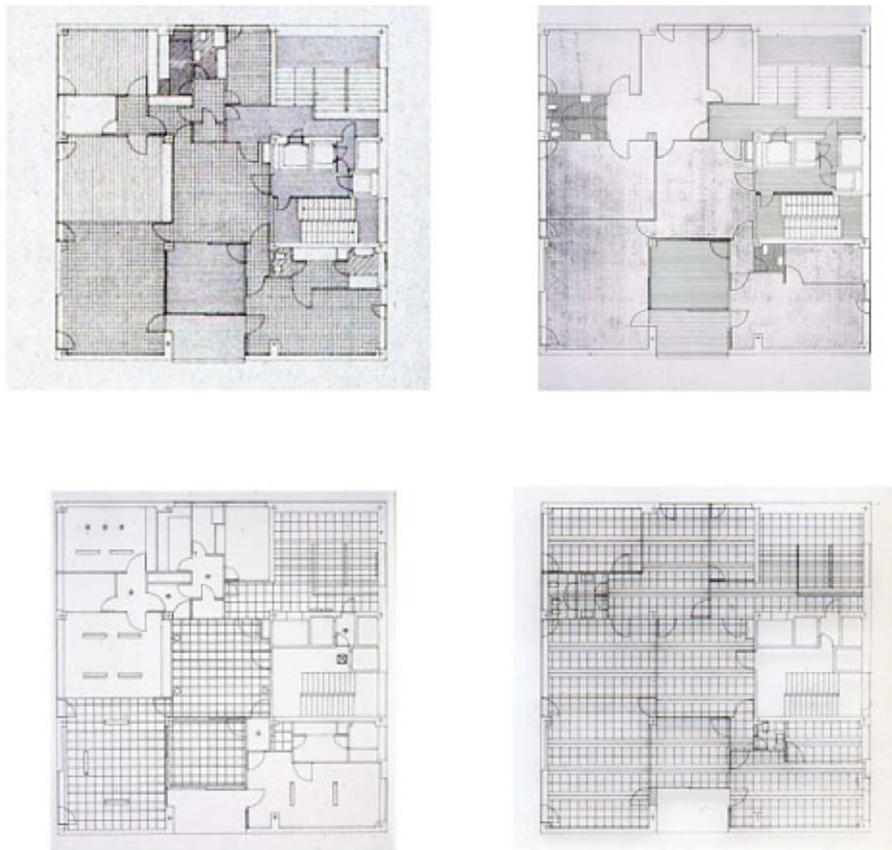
Plano de pavimentos del estado antes de la rehabilitación y plano de actuación en pavimentos de planta tercera. Josep Llinás 1985.
